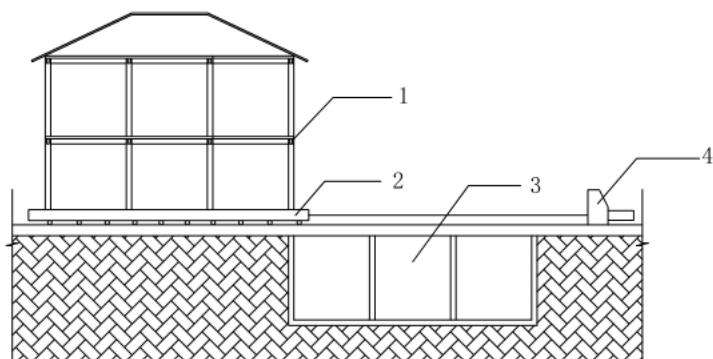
建筑物移位地下增层（先施工地下空间）示意图
